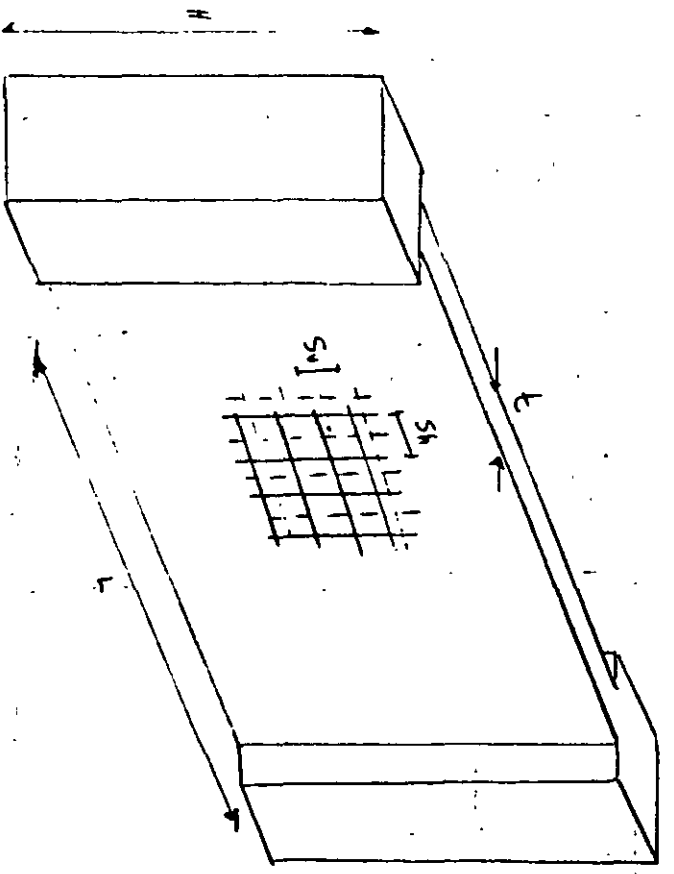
Requisitos geométricos y de refuerzo en muros de concreto
